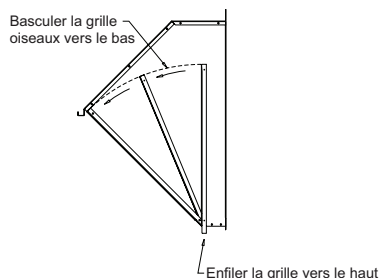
Placement de la grille oiseaux dans la coiffe de protection assemblée
